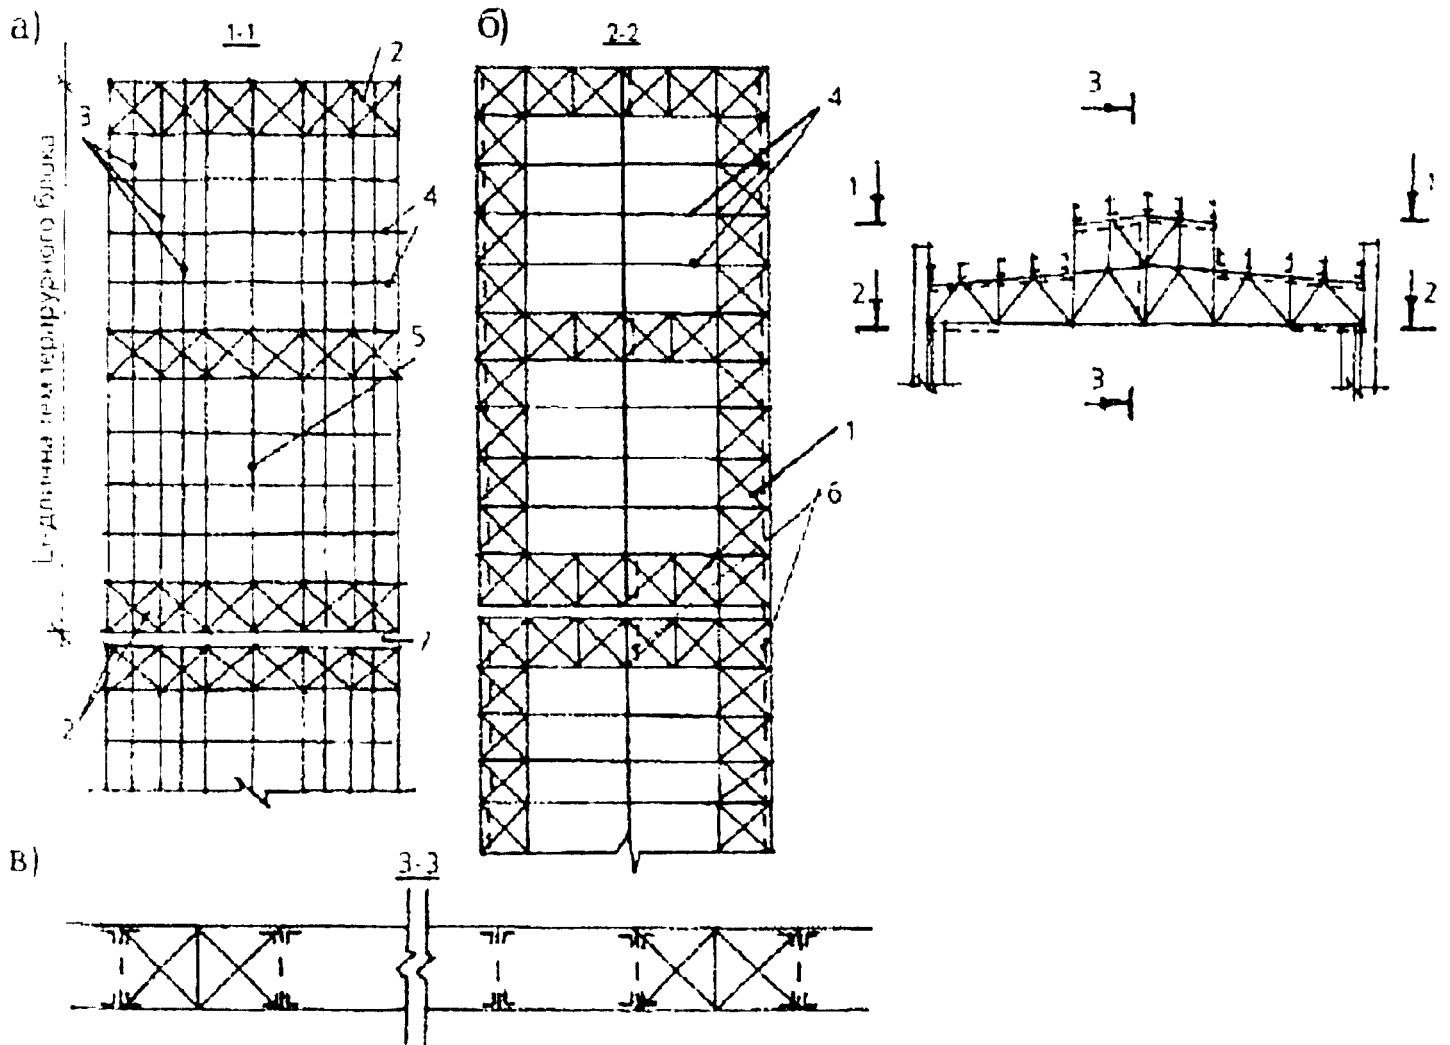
Одноэтажный металлический каркас промышленного здания. Связи в покрытии: а - связь по верхним поясам ферм; б - связи по нижним поясам ферм; в - вертикальные связи между фермами; 1 - нижние горизонтальные связи; 2 - верхние горизонтальные связи; 3 - прогоны; 4 - фермы покрытия; 5 - распорка; 6 - вертикальные связи; 7 - температурный шов
